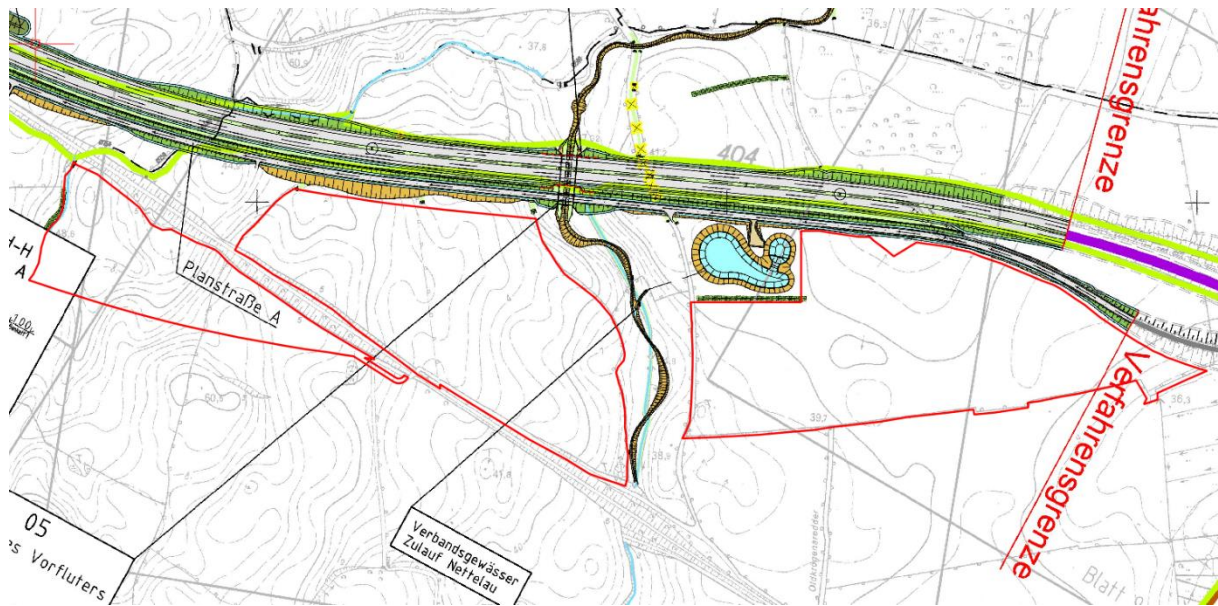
Ausschnitt Vorhabenbereich auf Planfeststellungsunterlage LBV, ohne Maßstab
